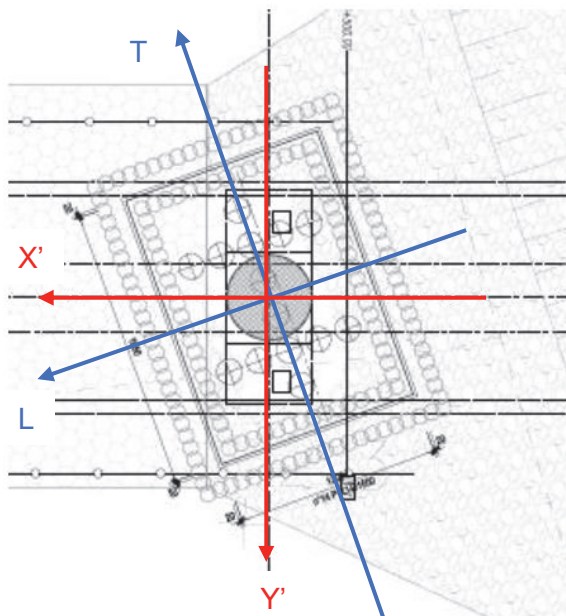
Pianta della fondazione ruotata di un angolo di 20° rispetto all'asse longitudinale dell'impalcato
